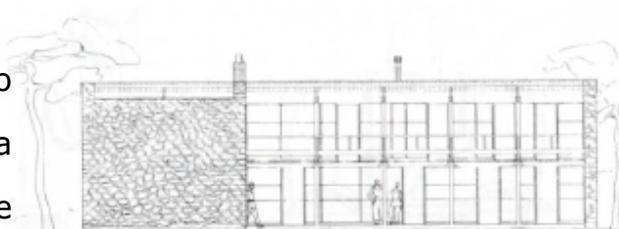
Casa Les Mathes - nas proximidades de La Rochelle; alvenaria com pedras da região, vigamento de madeira e telhas de fibrocimento; Esquema caixa - reinterpretação da estrutura com envoltório em alvenaria e estrutura interna em madeira compõem a planta livre, a estrutura independente reinterpretada e as cortinas de vidro;
